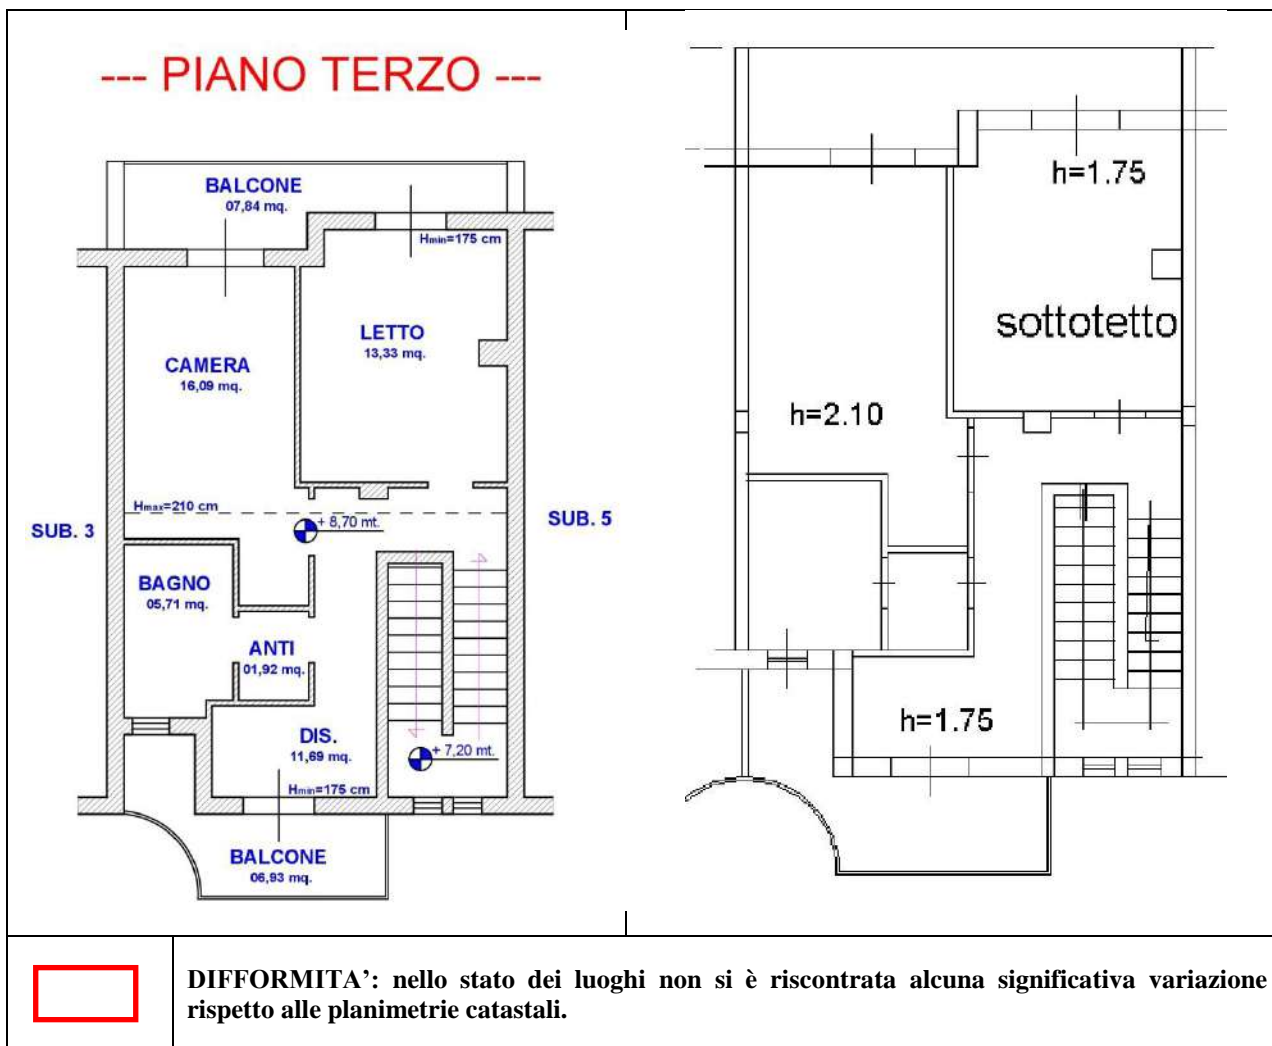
Confronto planimetrie stato di fatto e planimetrie catastali
